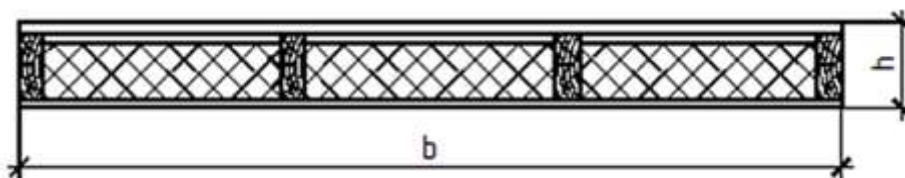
Поперечное сечение клеёфанерной плиты покрытия
